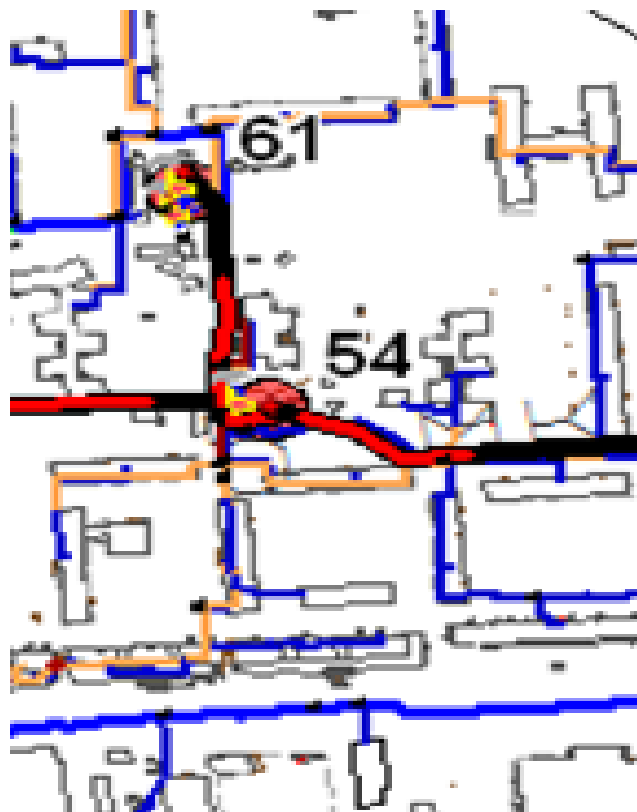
Схема прокладки трубопровода между котельными №54 и №61
